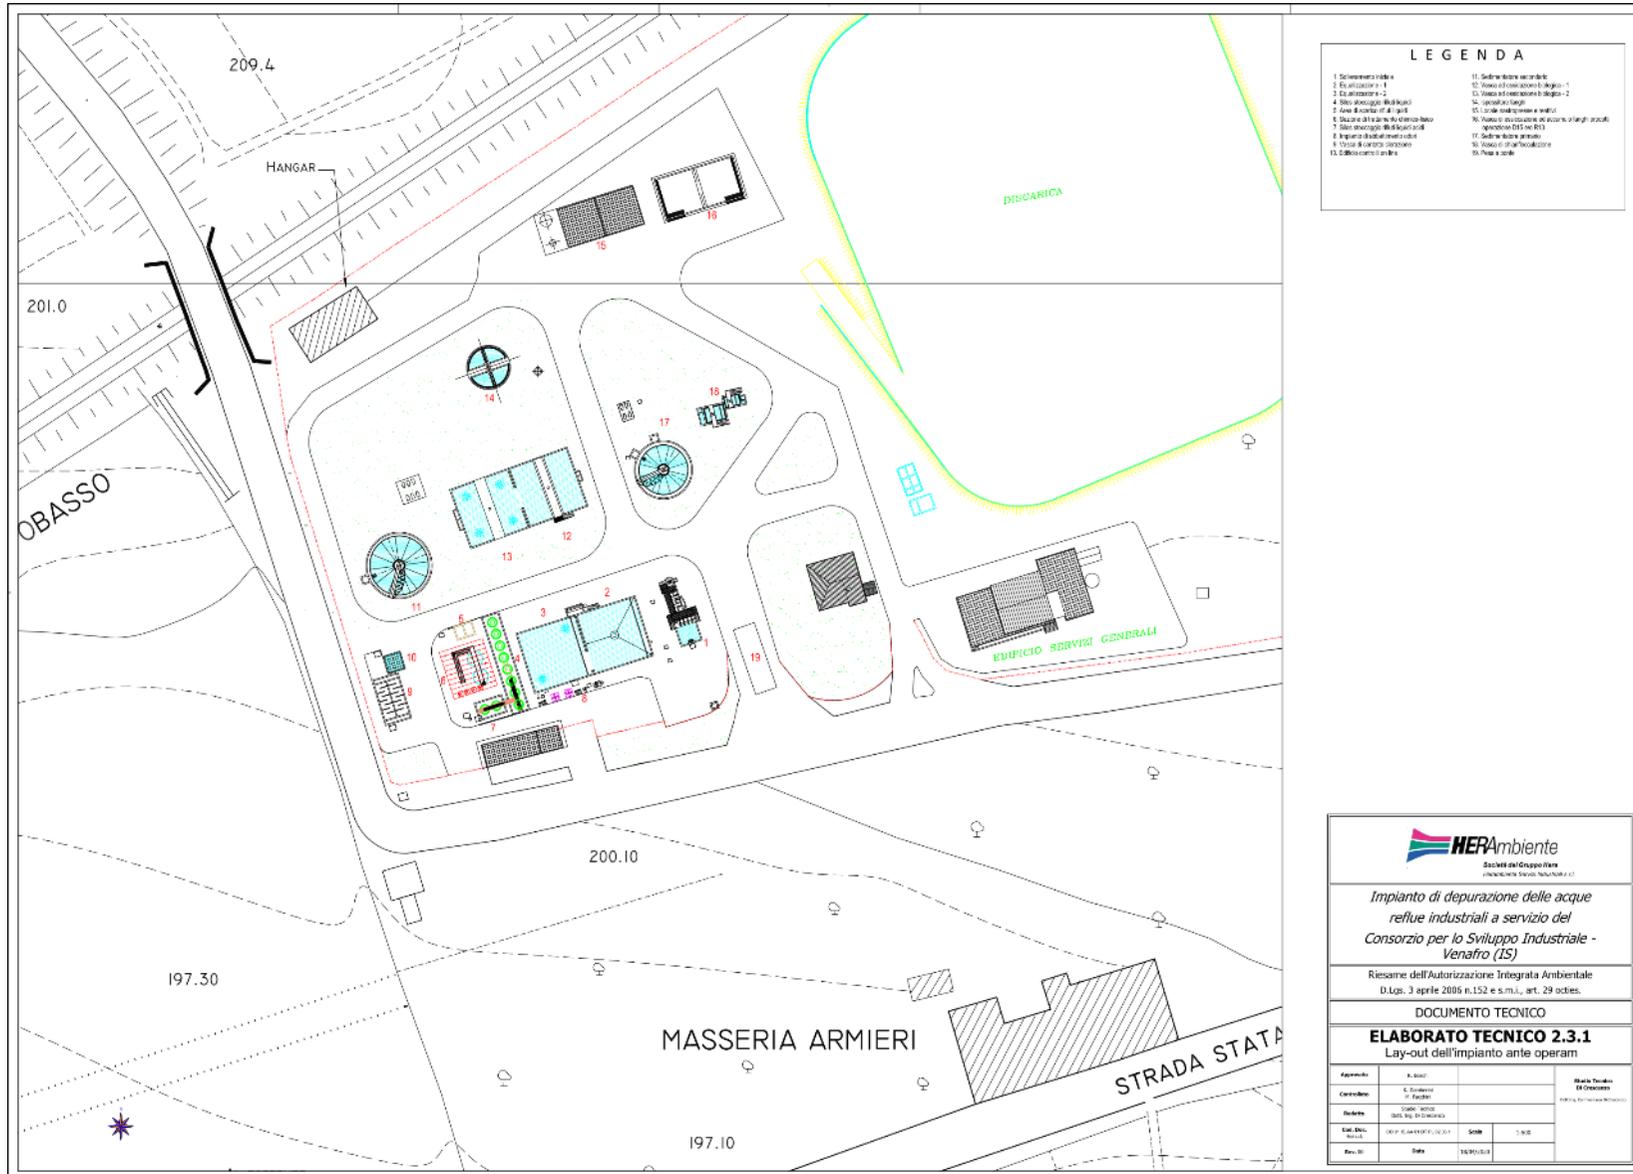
planimetria generale dell'installazione: assetto "ante operam"
